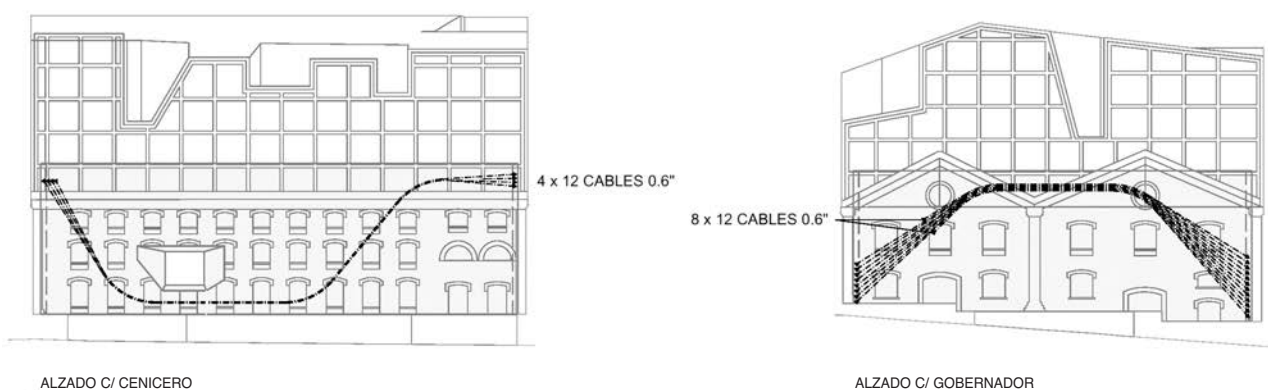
Muro perimetral. Solución con trazado antifunicular de los cables.
